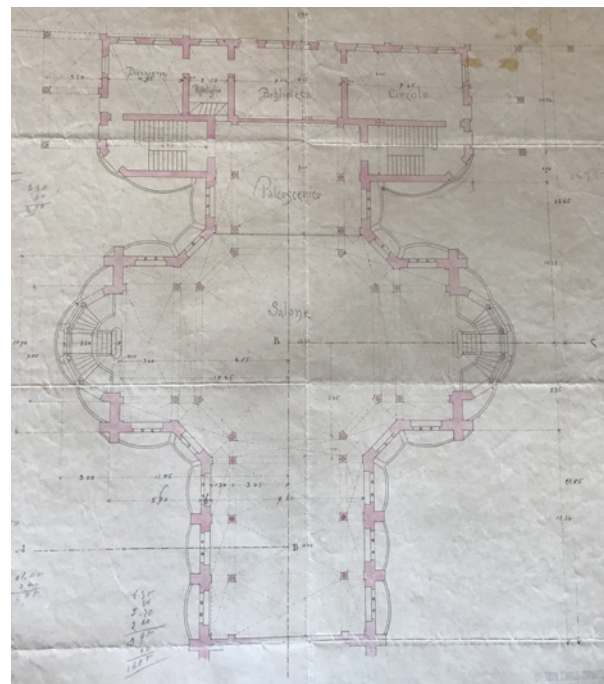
Chiappetta, disegno della pianta del pian terreno ulteriormente modificata, scala 1:100, non datata, Archivio Beato Angelico, Milano
